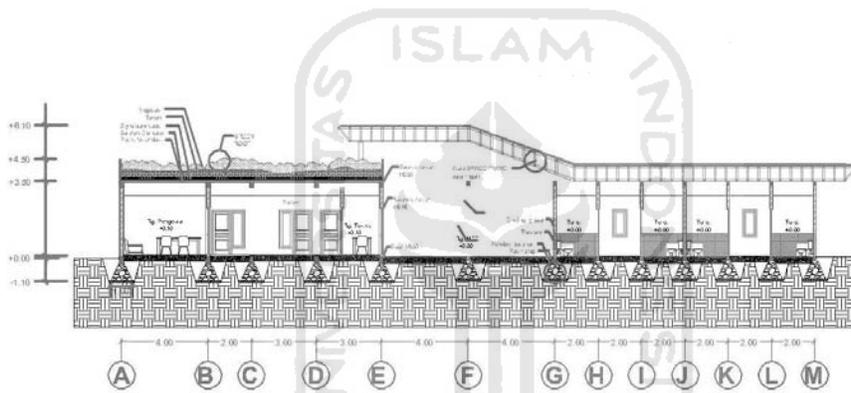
Potongan Bangunan Skematik Musholla (Spritual)
